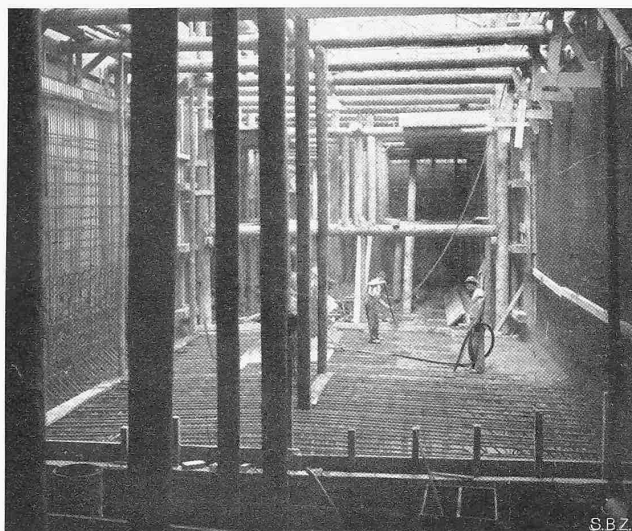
Betonierung des Bodens der Innenkonstruktion
